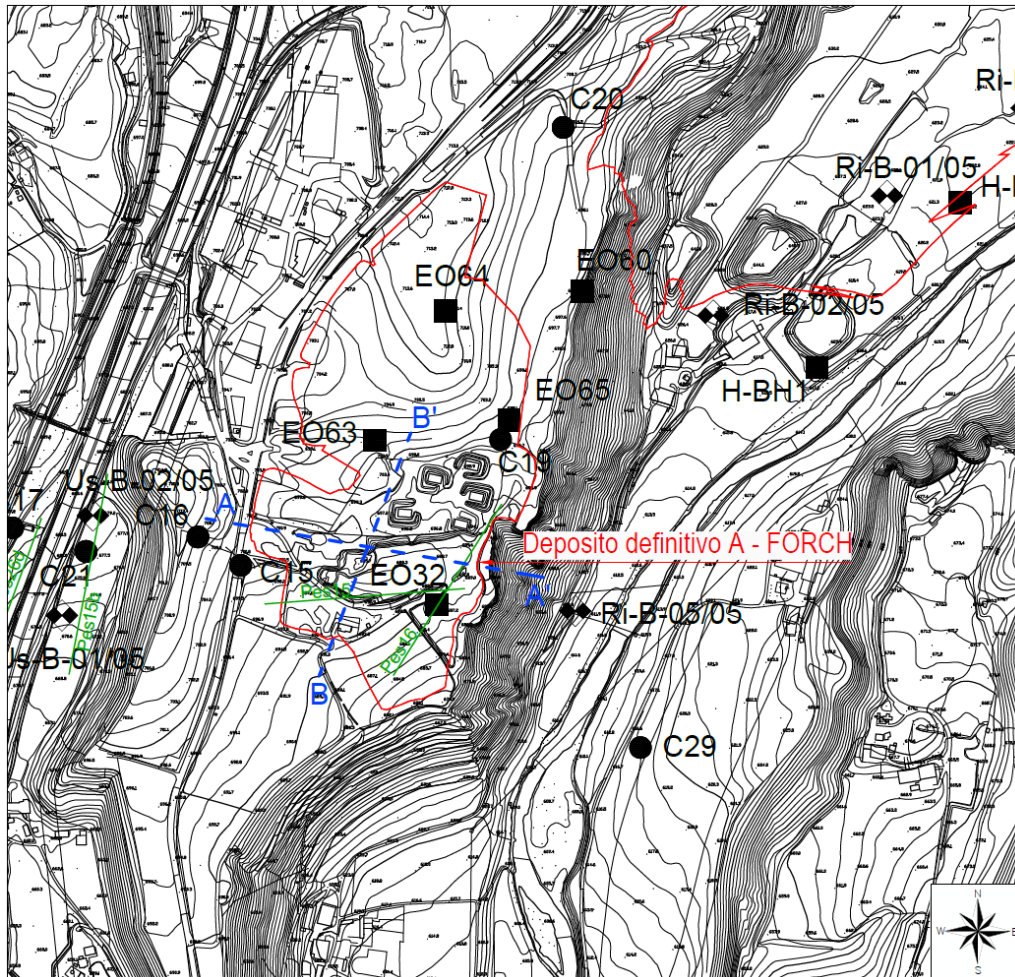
Planimetria dell'area con ubicazione delle indagini.
